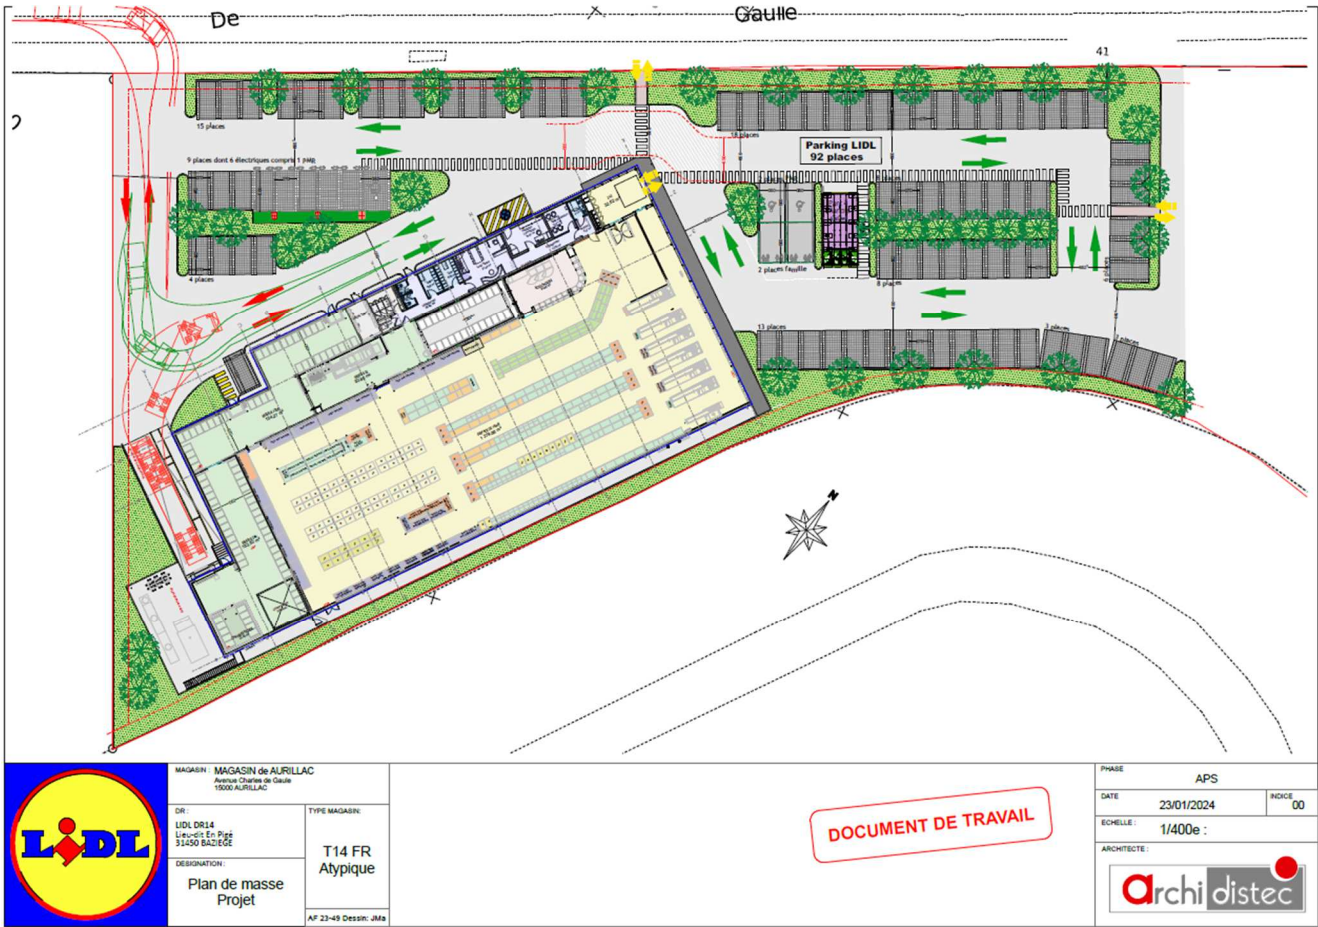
Plan de masse du projet (source : Archidistec, 2024)
